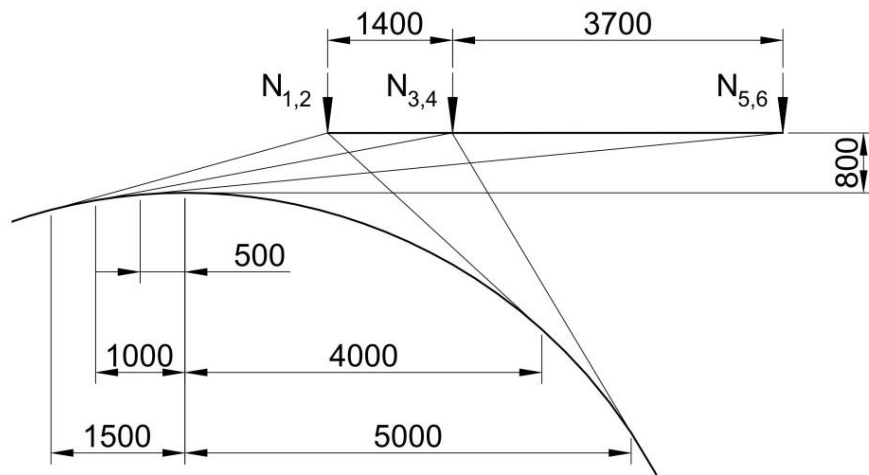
Схема распределения усилий. Сечение №IV.
